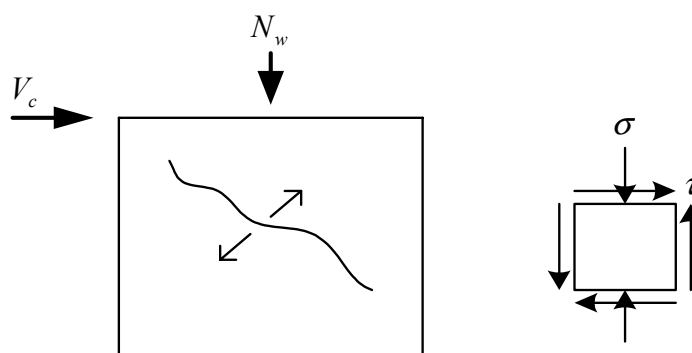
鋼筋混凝土牆腹剪開裂示意圖
